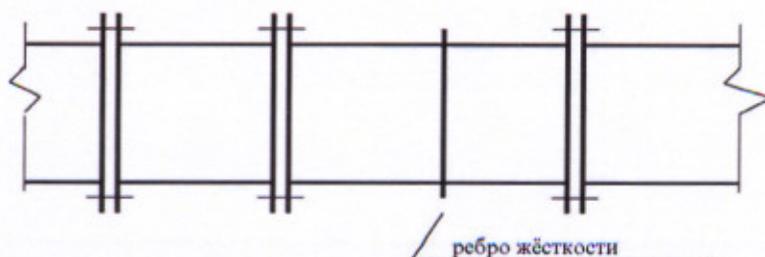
Принципиальная схема конструкции воздуховода из оцинкованной стали на фланцевых соединениях.
